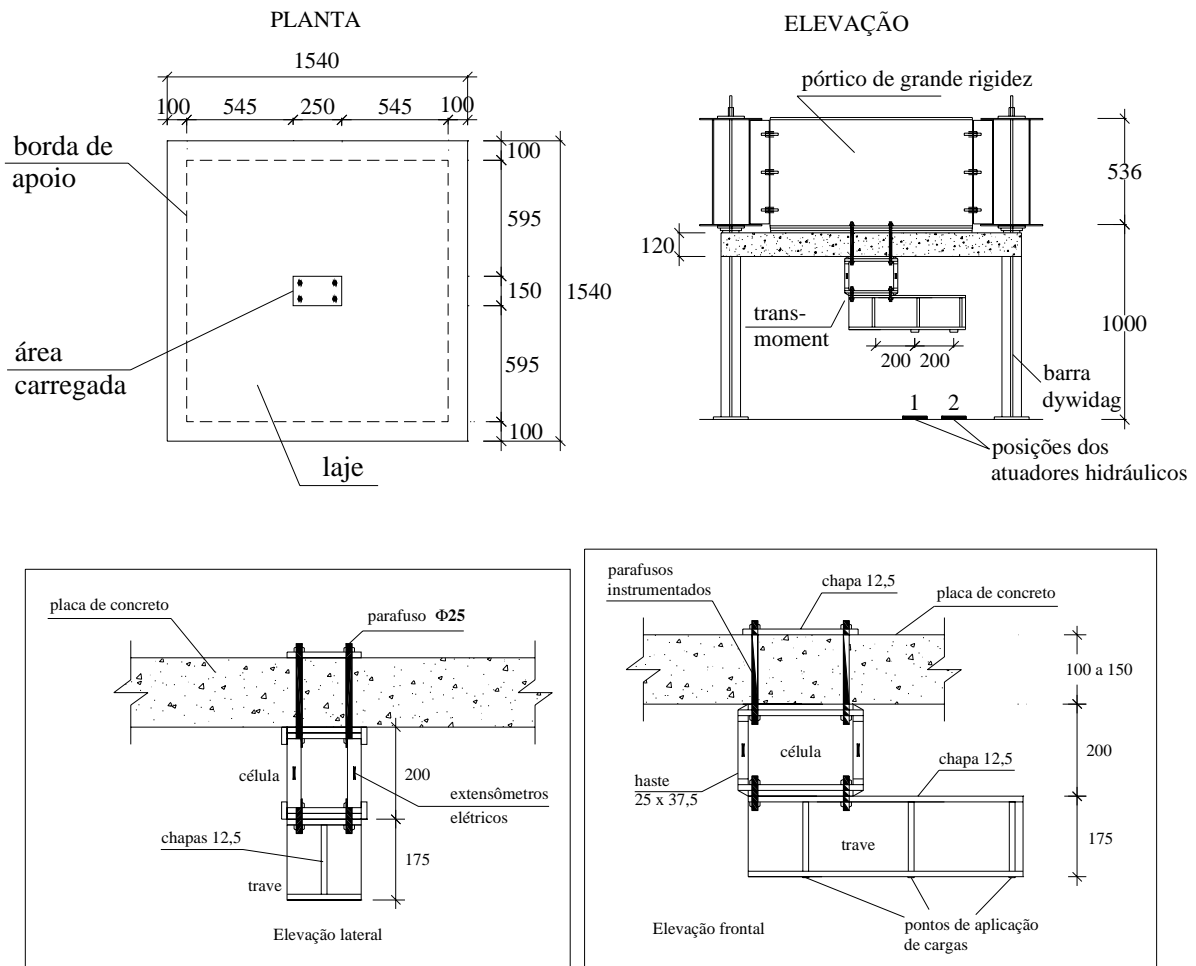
Sistema de aplicação de carga e dimensões das lajes e detalhe do “trans-moment” utilizado por CORDOVIL (1995) (mm)
